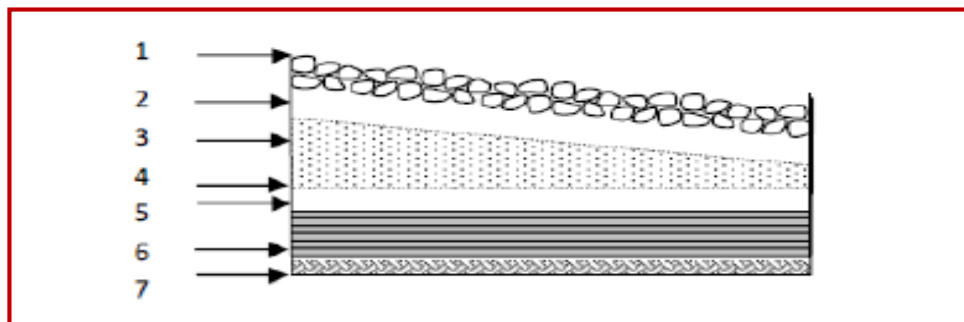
Coupe verticale du dernier plancher (terrasse inaccessible).
